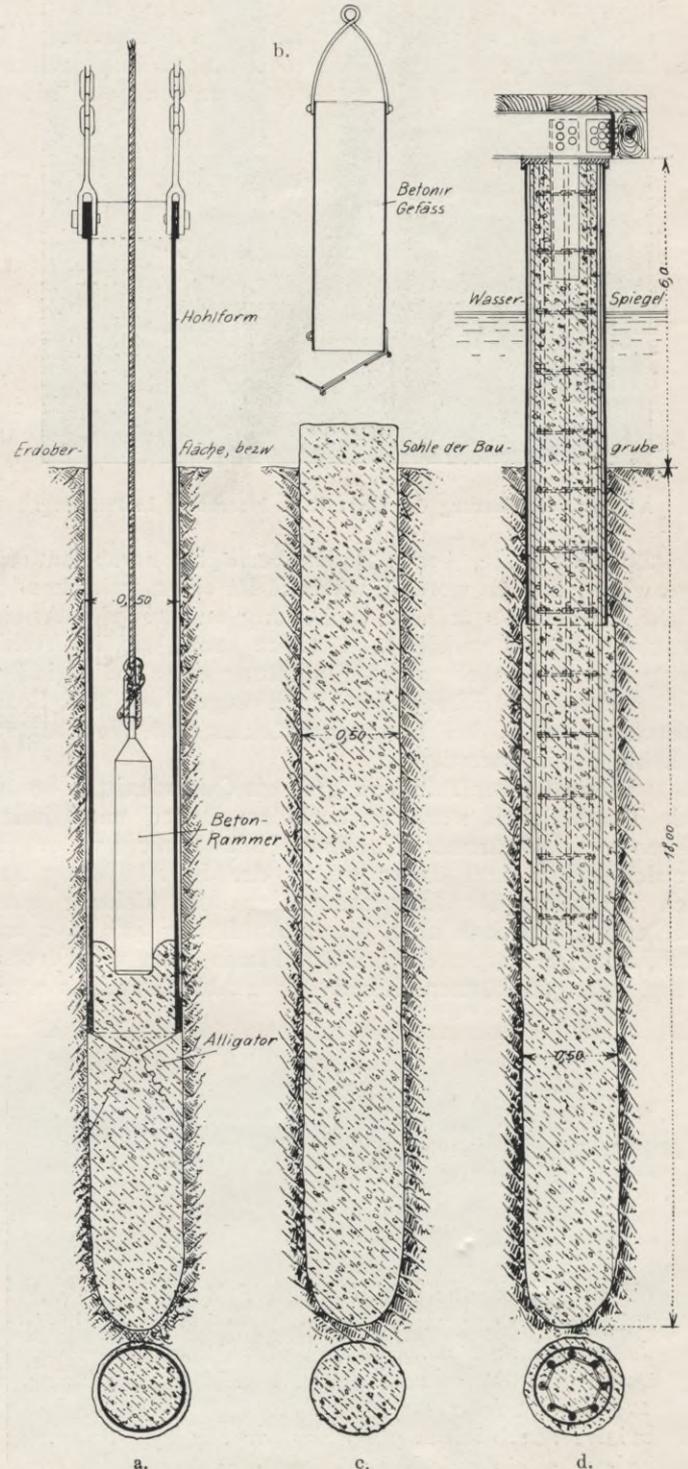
Mit dem Alligator-Pfahlschuh erstellte Betonpfähle.
